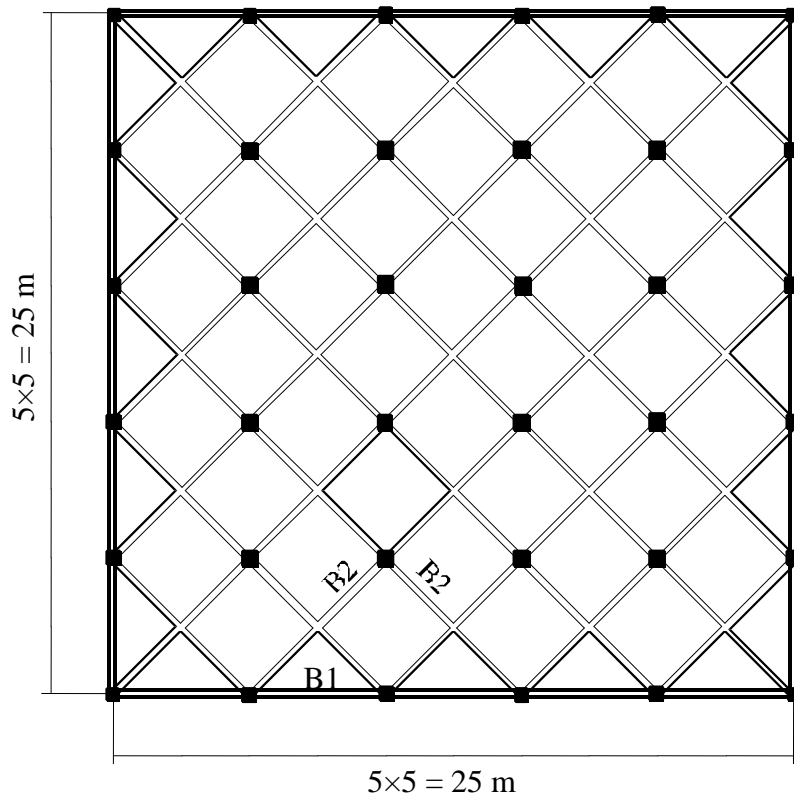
Typische Decke im Grundriss (Skew-Panelled Stäbe)
